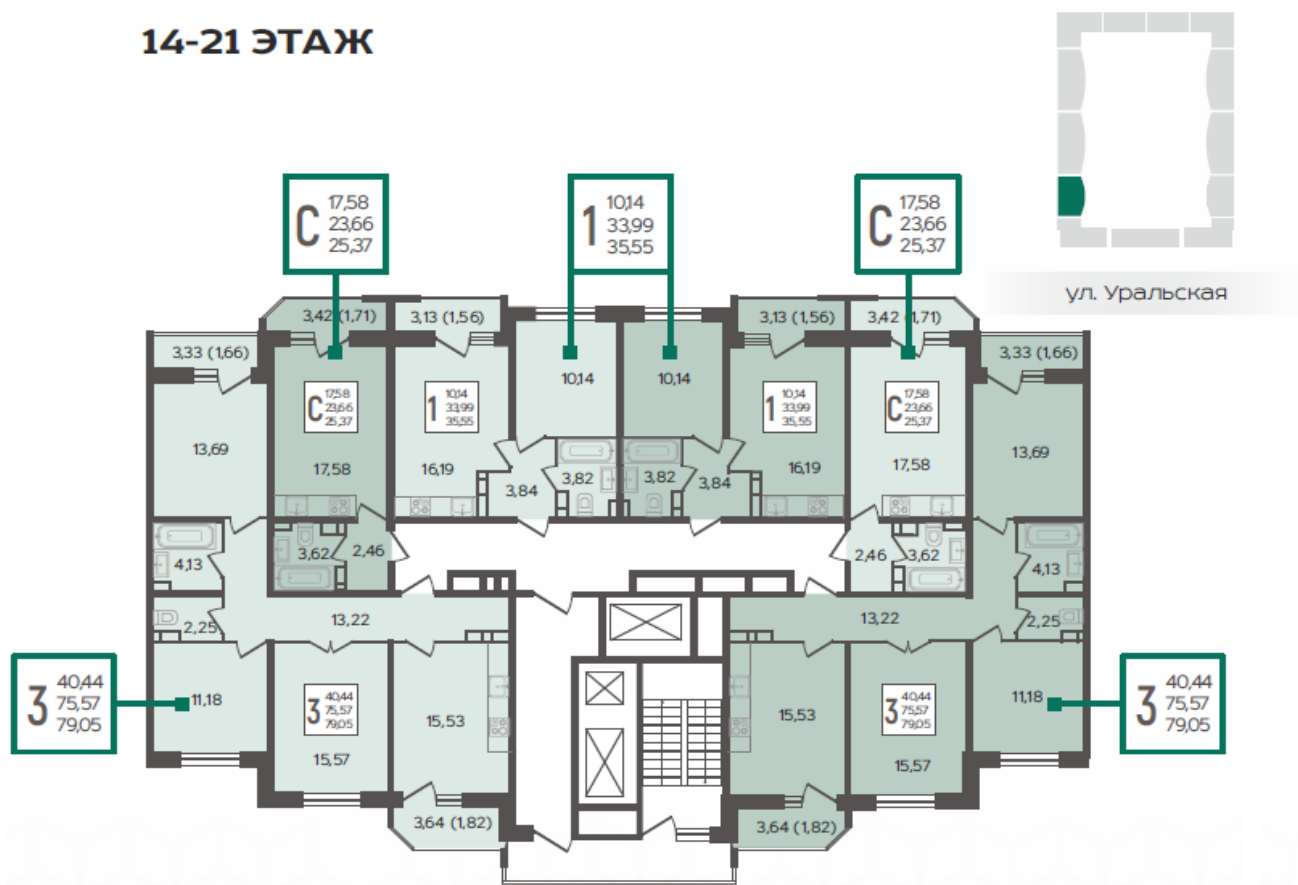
Типовой план 14-21 этажа БС-2 ЖК URAL
